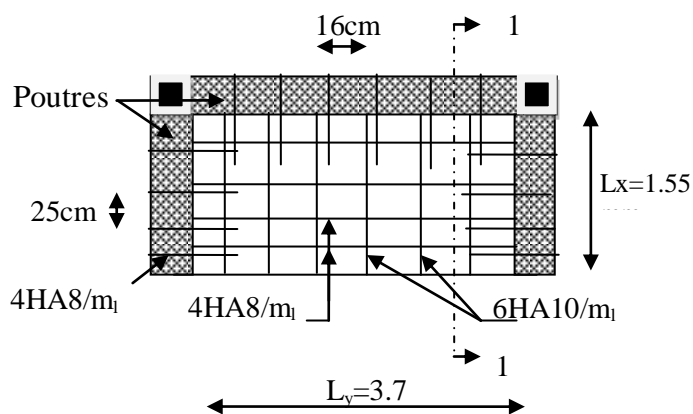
27: schéma de ferrailage de la dalle sur 3 appuis.
